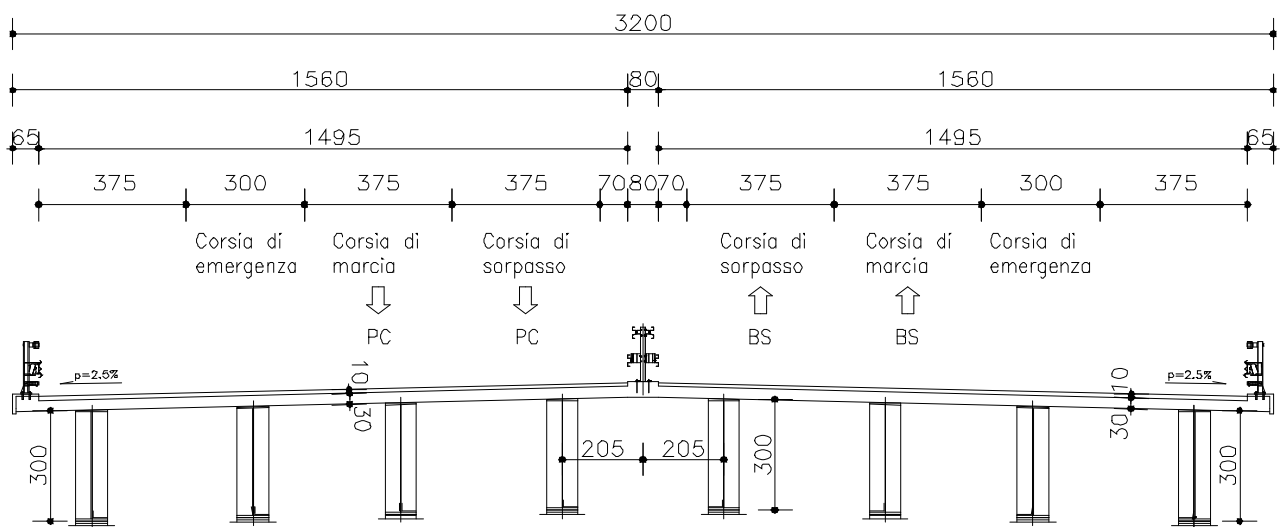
Sezione trasversale dell'impalcato in corrispondenza delle pile P25÷P36
